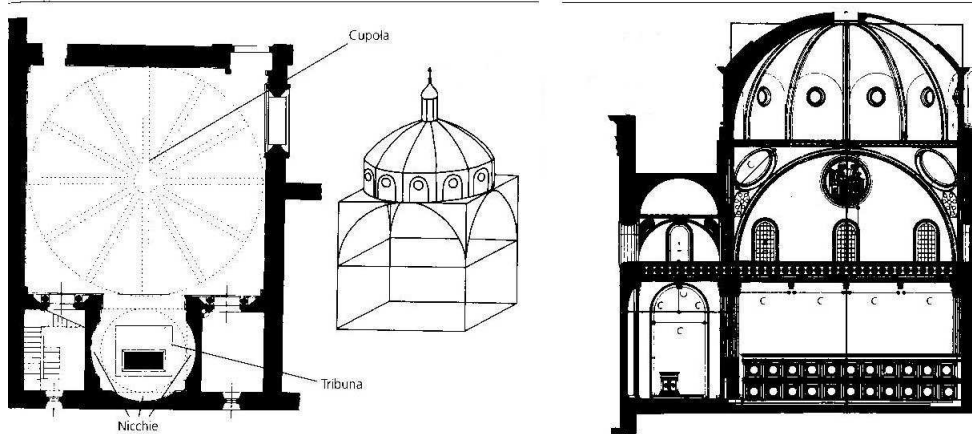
Pianta e schema dell'alzato della Sagrestia Vecchia
